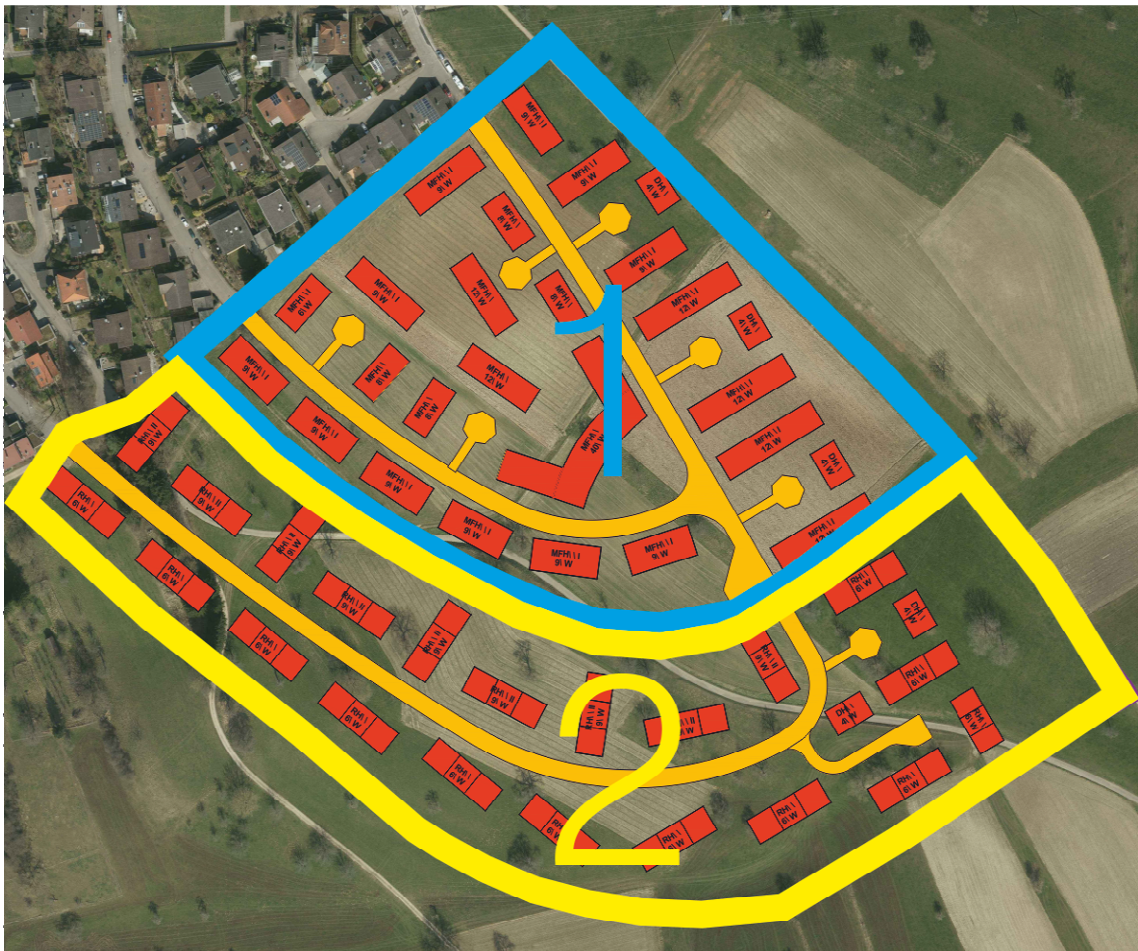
Darstellung Bauabschnitte, Quelle: Stadt Lörrach, Planungsstand 10.03.2016
